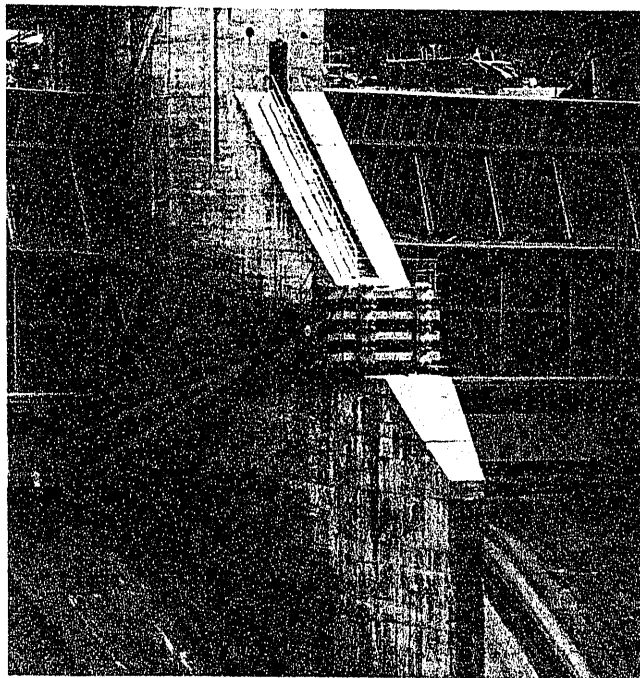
Salto de Castro. Brazos de la viga cajón y viga soporte de los cojinetes de giro.
